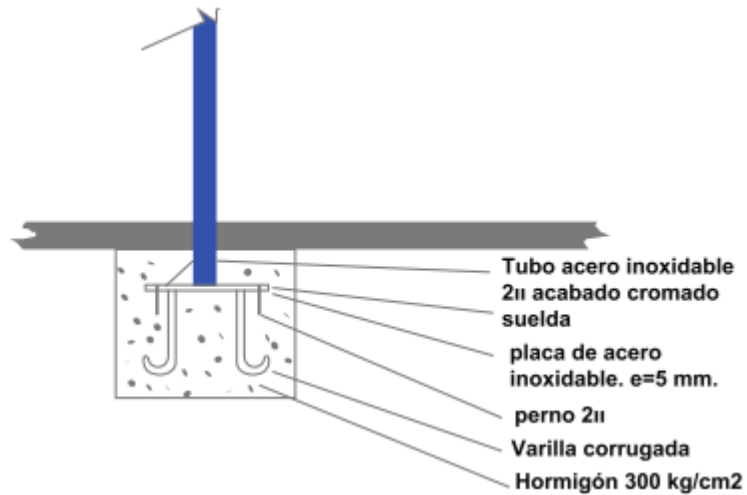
Plano de detalle de tubo metálico en cicloparqueador
